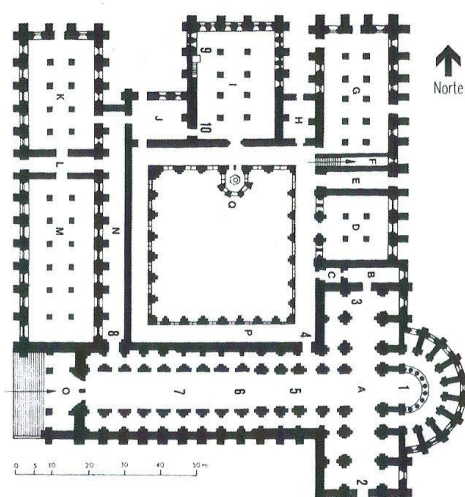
Planta medieval do convento de Santa Maria de Alcobaça.
